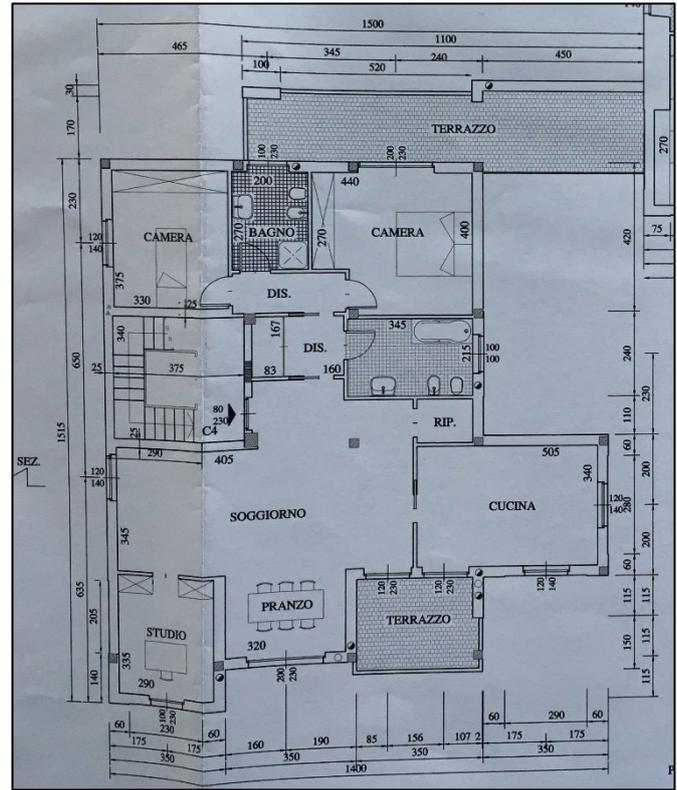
Estratto pianta piano primo dell'edificio tipo (disegno fuori scala)
